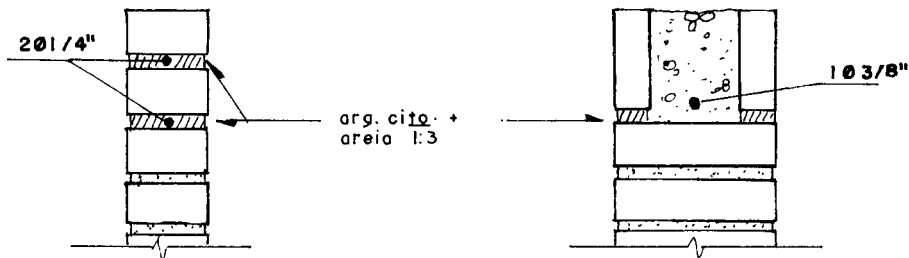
Cinta de amarração em alvenaria de tijolo maciço
